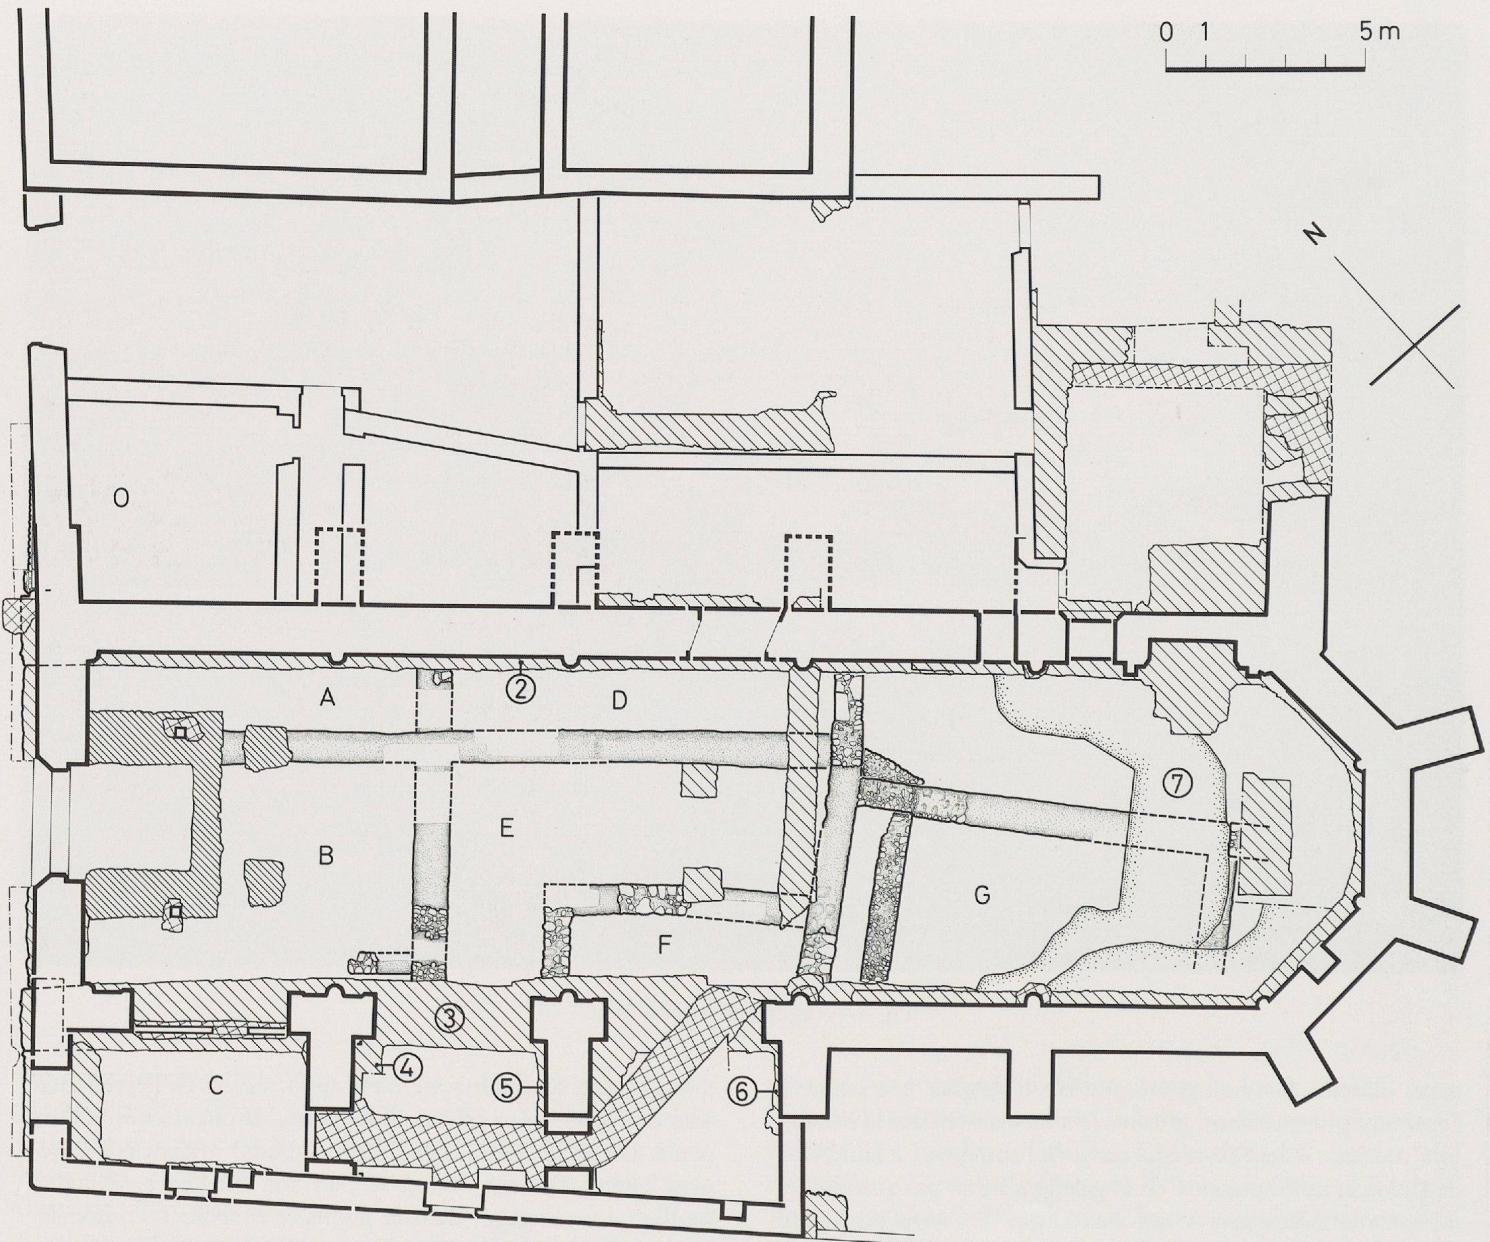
Plan général des structures urbaines et du premier projet de l'église. Ech: 1:200.
